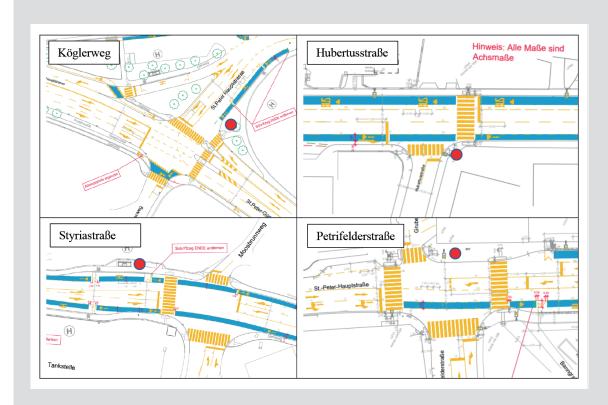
Hauptbeobachtungspunkte an vier Kreuzungsbereichen mit St. Peter-Hauptstraße
